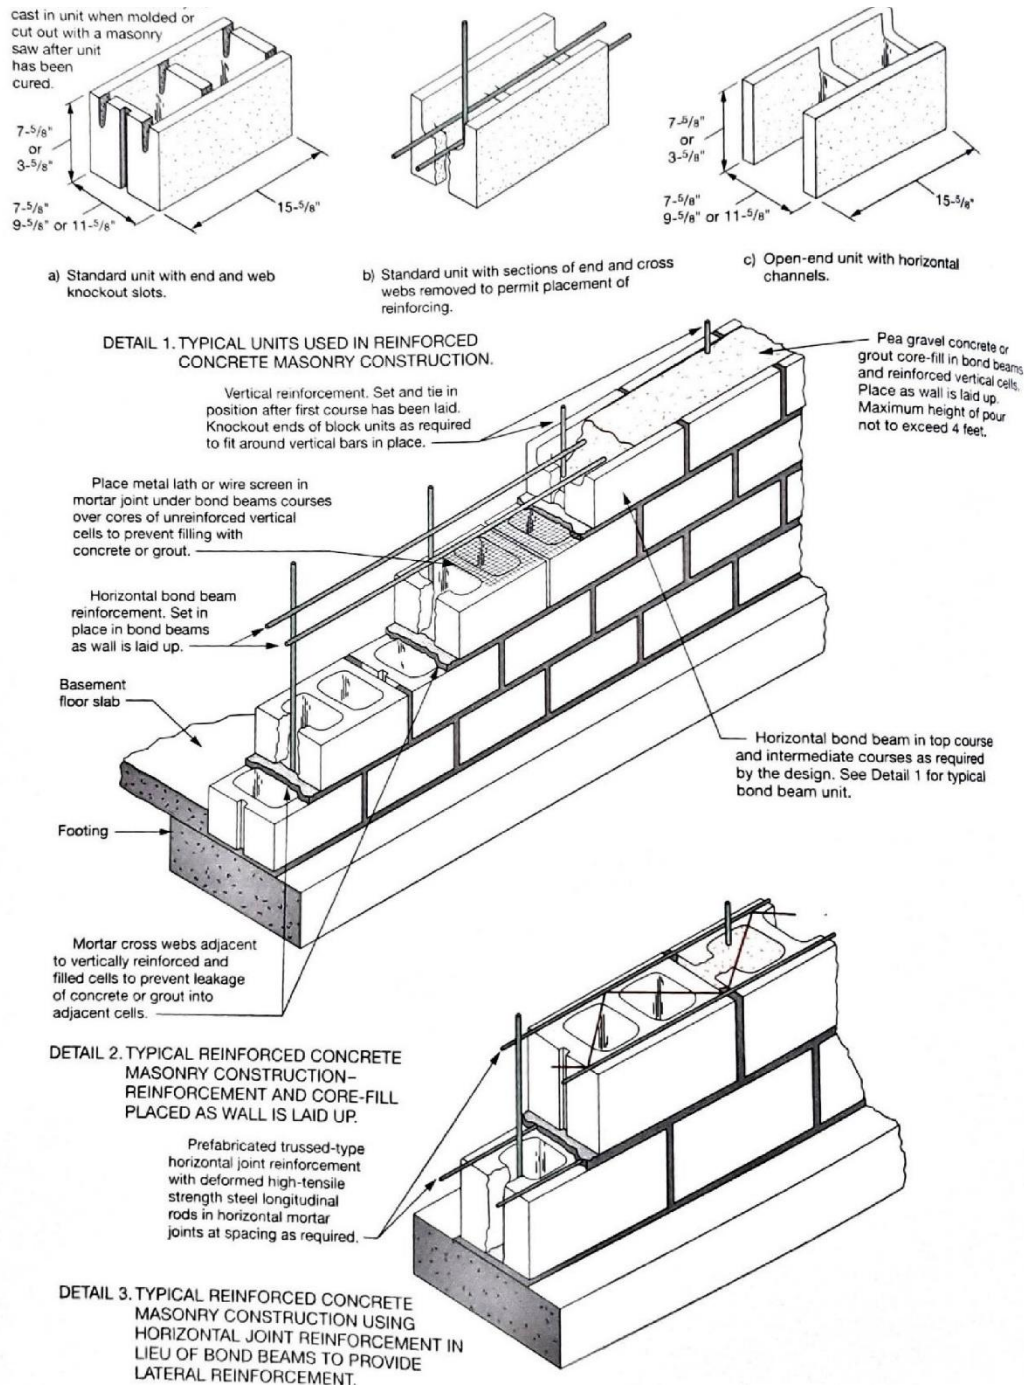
Detalles de los bloques No.8 con varillas horizontales y verticales cada cuatro hiladas.
